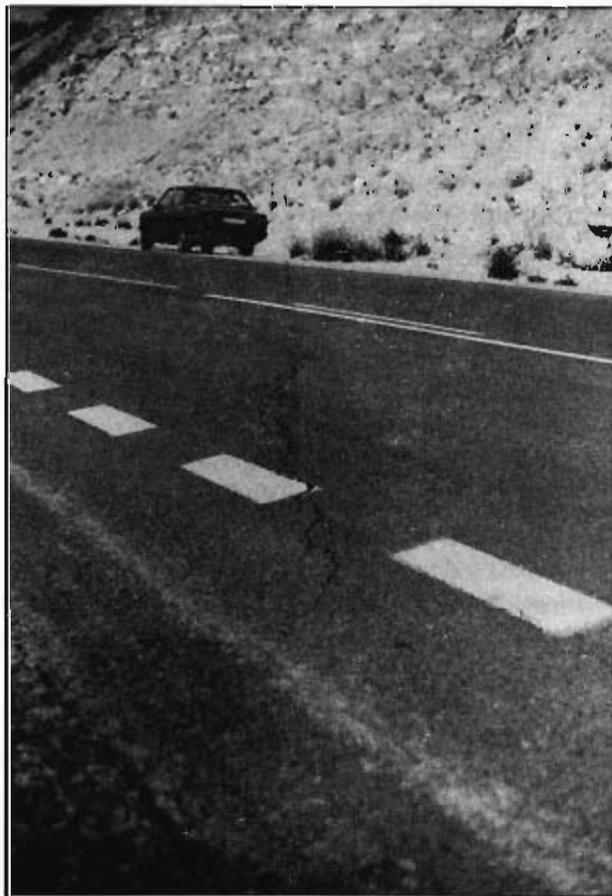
Grietas en la carretera C-321 cuando discurre sobre el grupo 321c, cerca de Ubeda.
